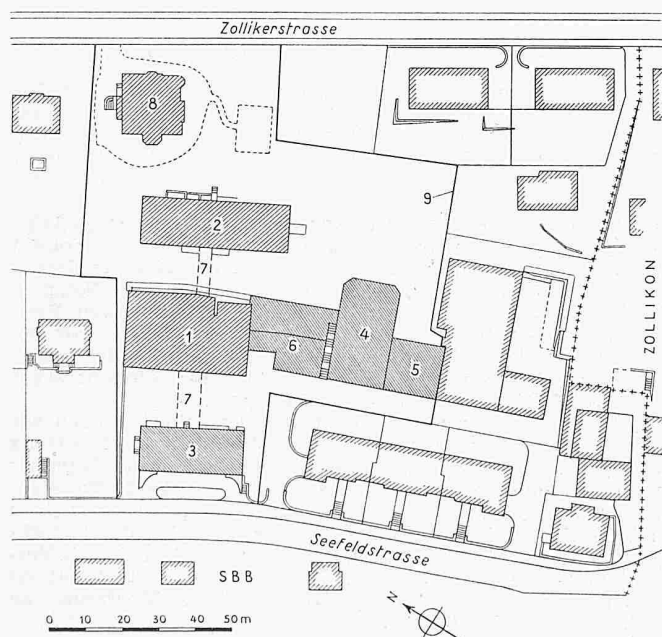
Lageplan 1:2000 der SEV-Liegenschaft
